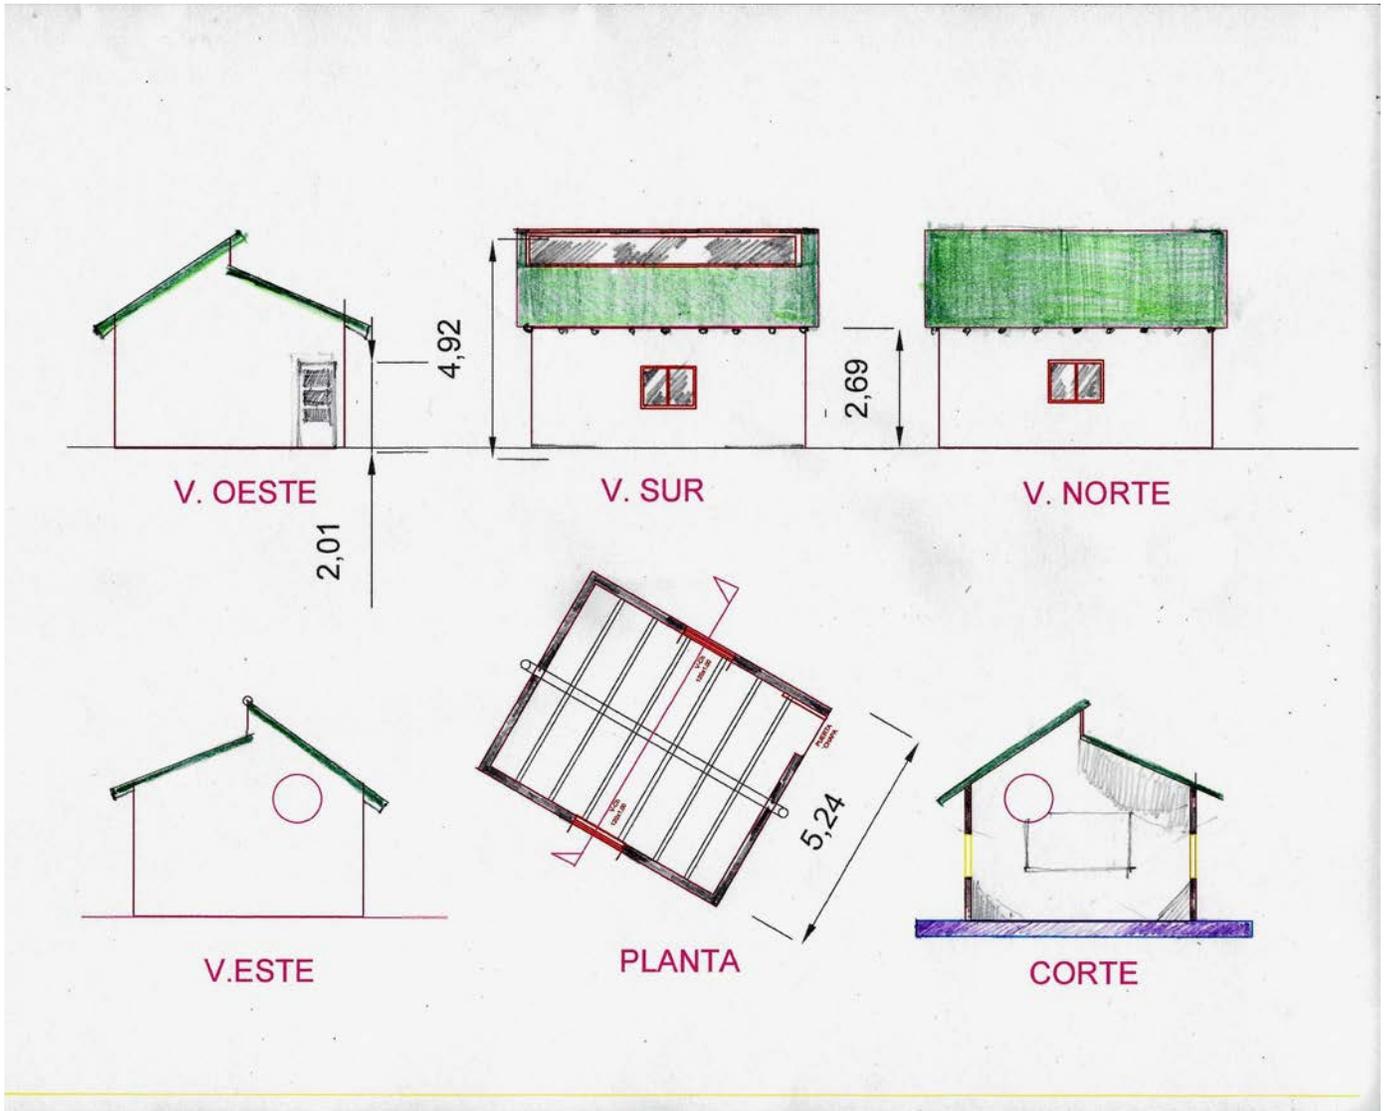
y 30-Diagrama de Planta General y detalles del Aula
